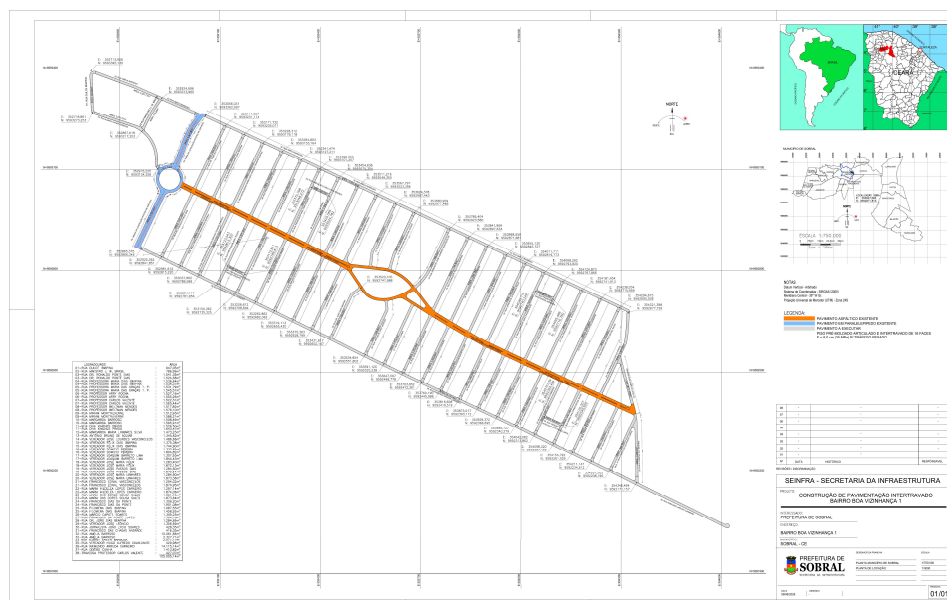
Planta de locação da pavimentação intertravada no Bairro Boa Vizinhança 1.
